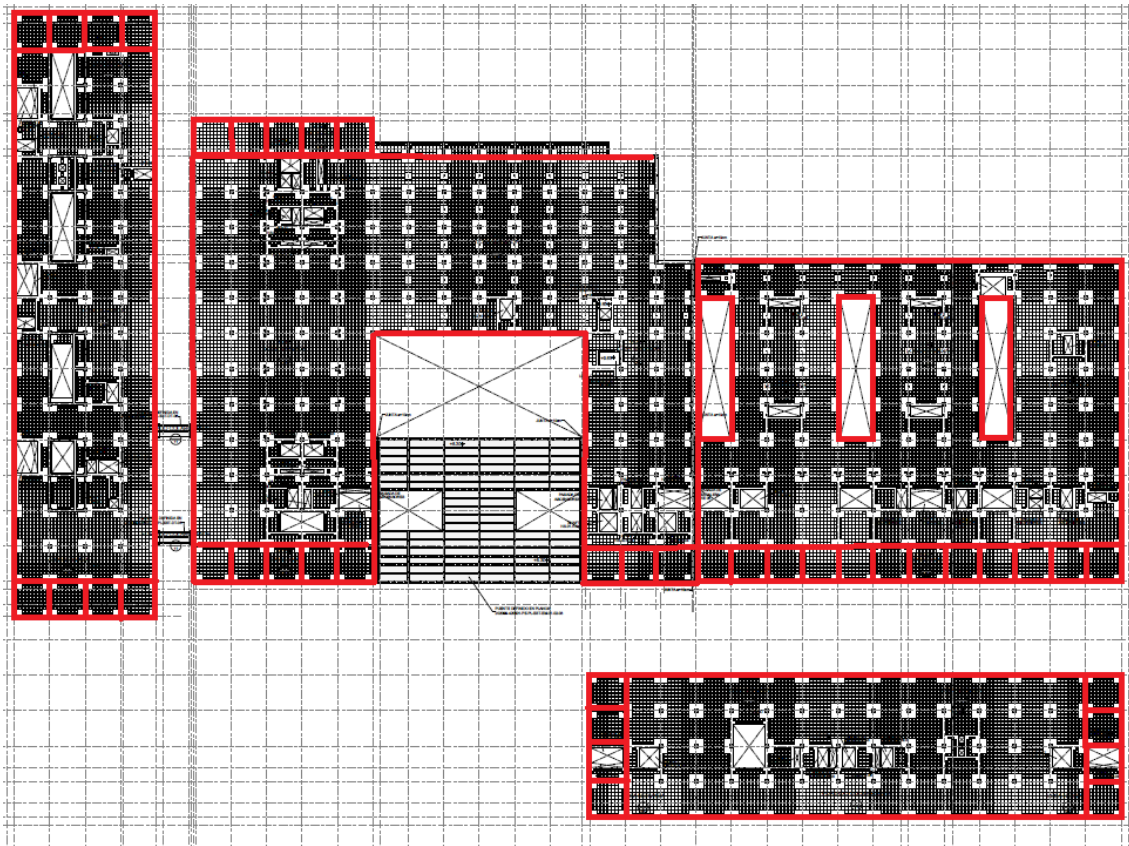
Planta típica. En rojo vigas de canto perimetrales
